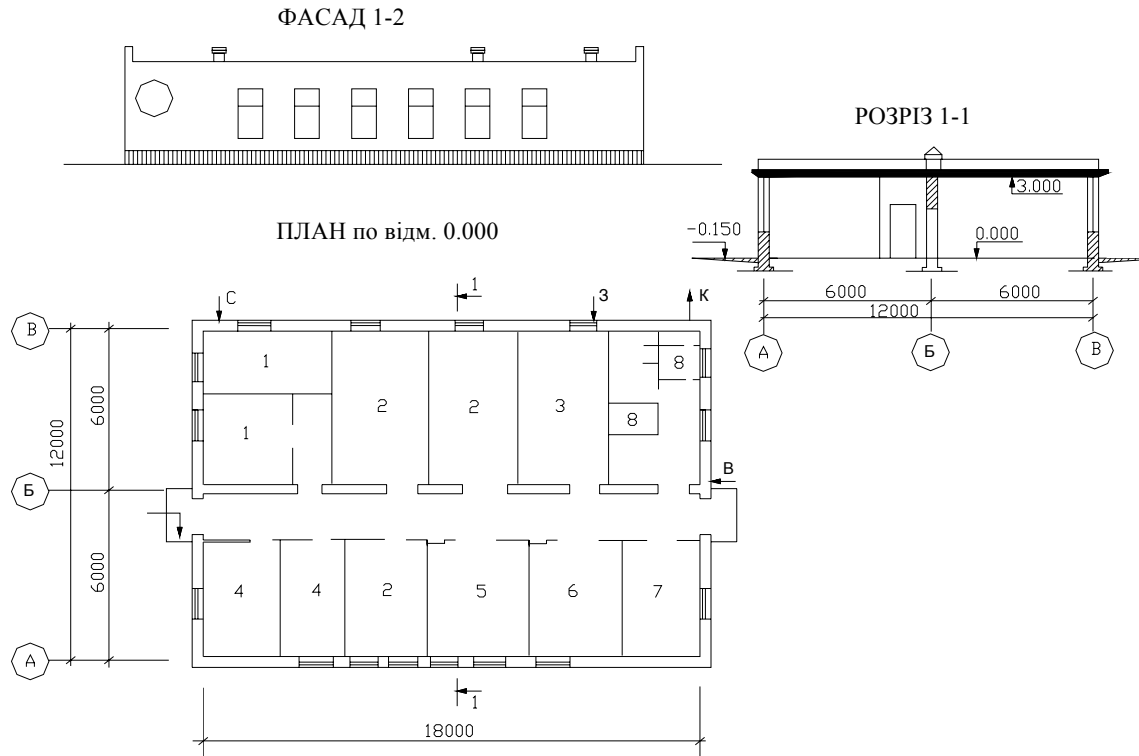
Схема службово-побутового будинку для аеродрому:
